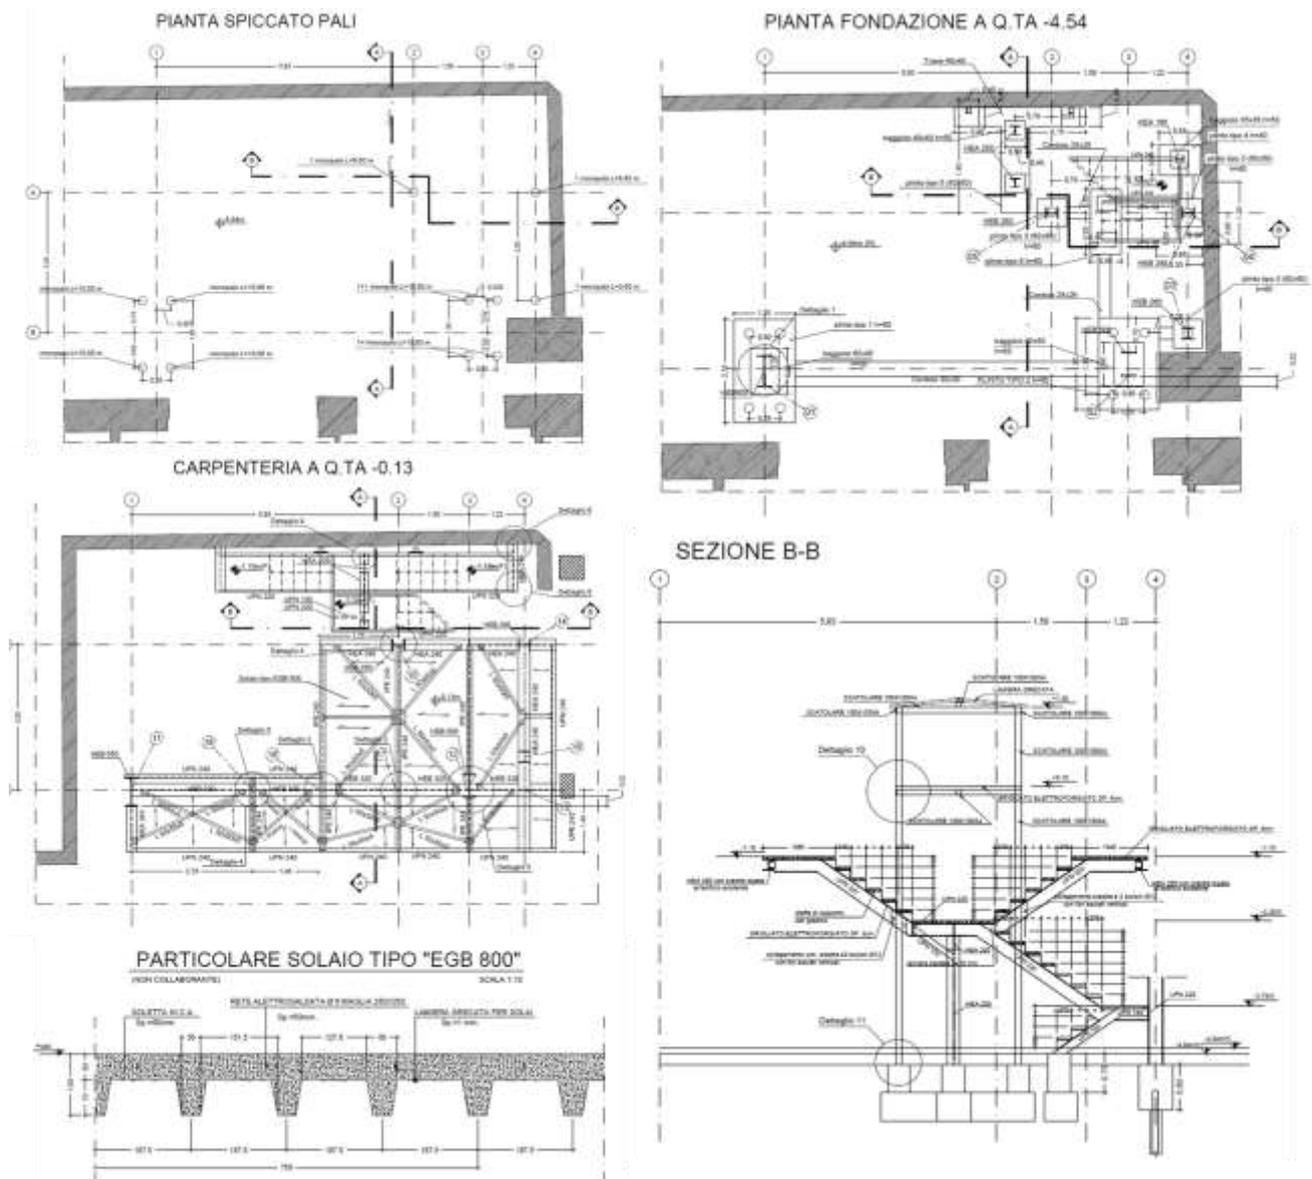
Stralcio progetto strutture (elaborato STR 001 del PE)
